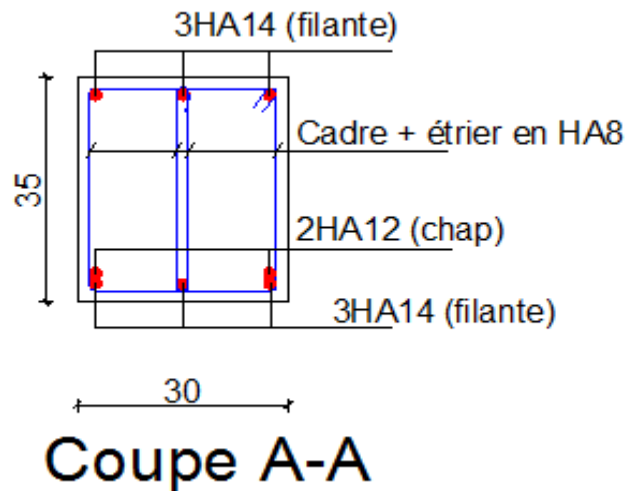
5: Ferrailage en travée d'une poutre secondaire.
